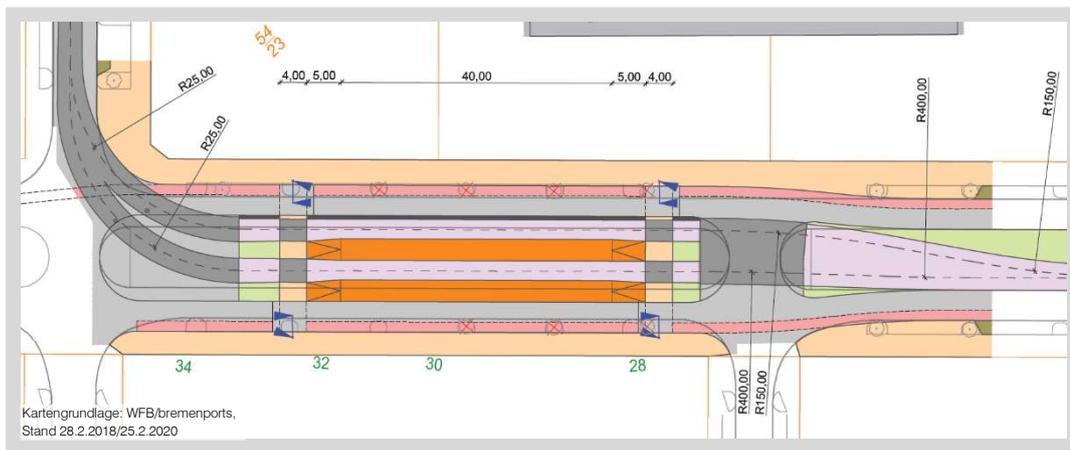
Ausschnitt Lageplan Endhaltestelle K.-Johnsen-Boulevard
